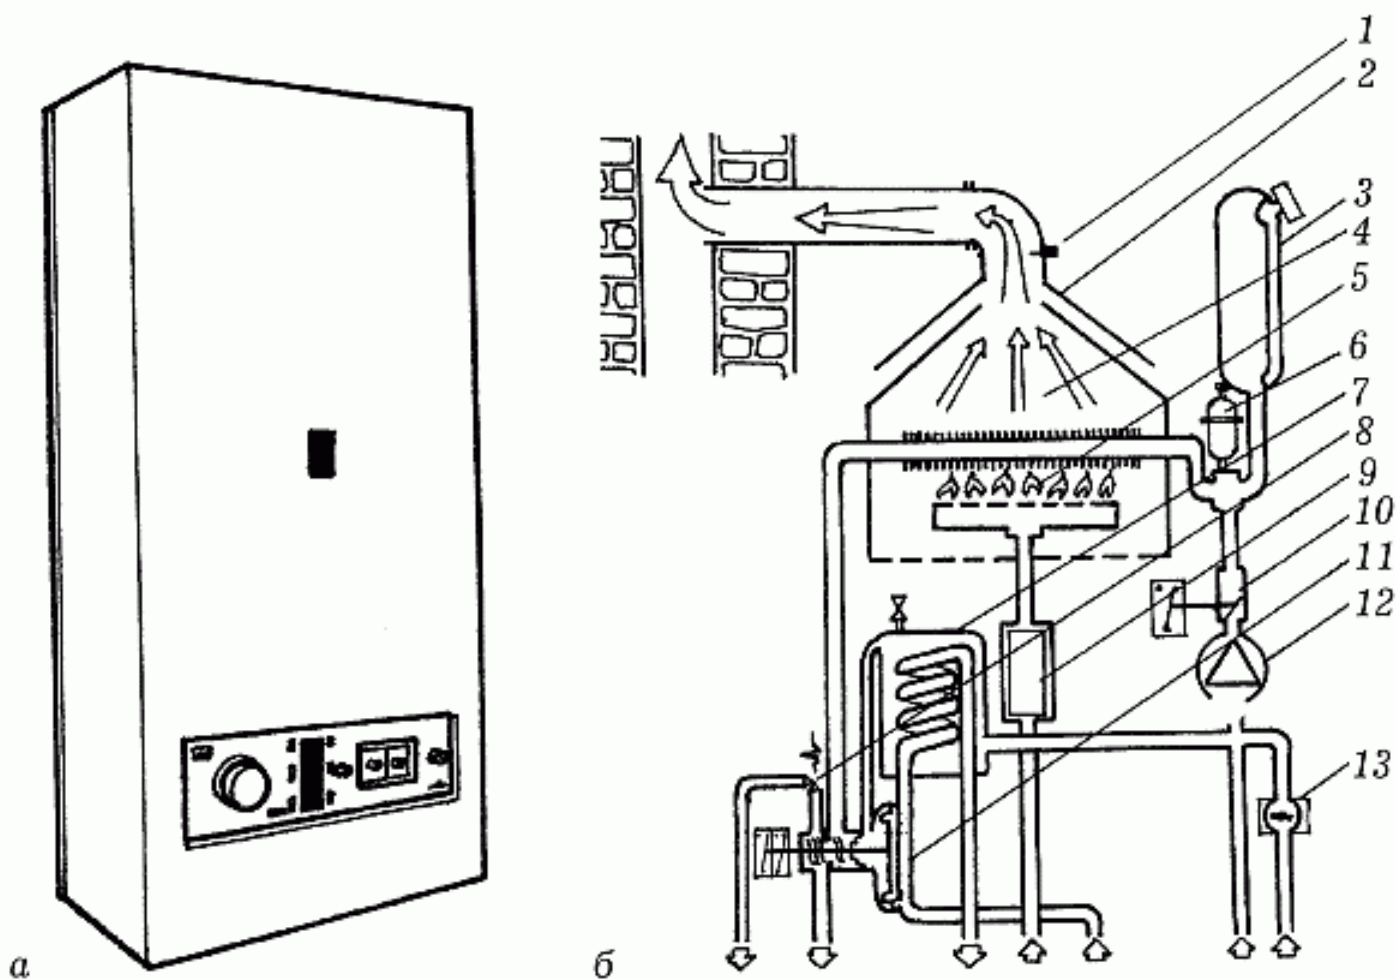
Современный газовый котел: а – внешний вид; б – схема работы: 1 – устройство контроля; 2 – прерыватель тяги; 3 – расширительная емкость; 4 – теплообменник; 5 – газовая горелка; 6 – воздушный вентиль автоматический; 7 – теплообменник системы водоснабжения; 8 – предохранительный клапан; 9 – арматура подачи газа; 10 – устройство, предотвращающее потерю отопительной воды; 11 – устройство управления («только подогрев», «только отопление» или «подогрев и отопление»); 12 – насос циркуляционный; 13 – наполнительный вентиль
